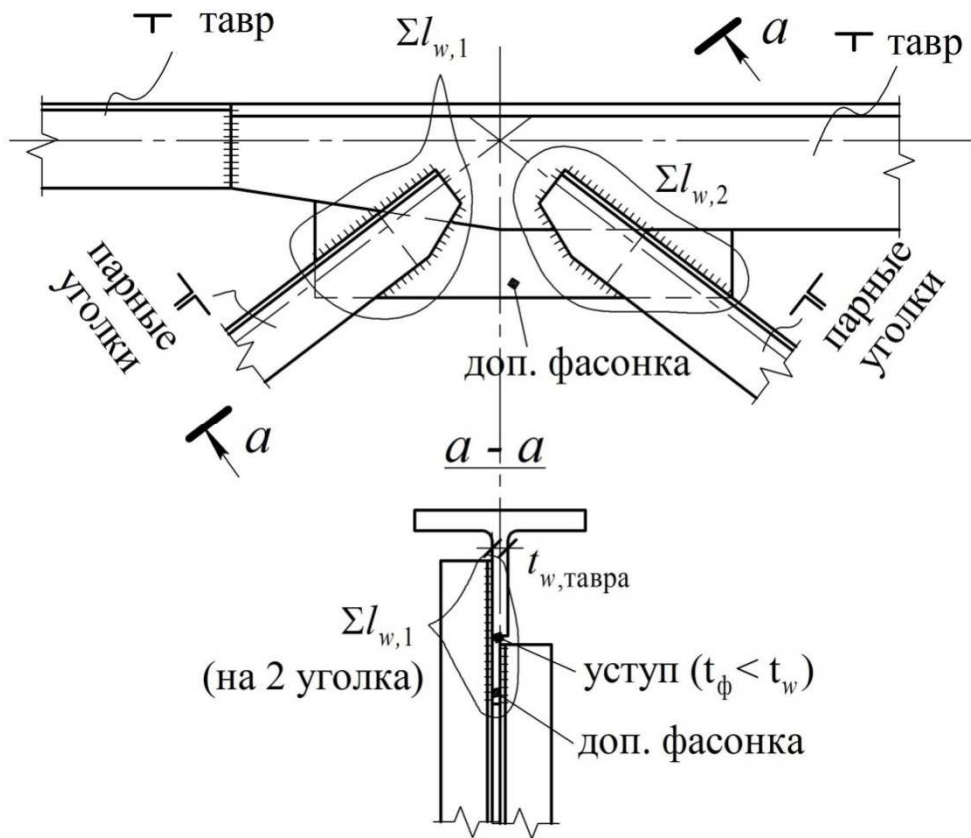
Вариант узла верхнего пояса стропильной фермы из тавра, решетки из уголков
